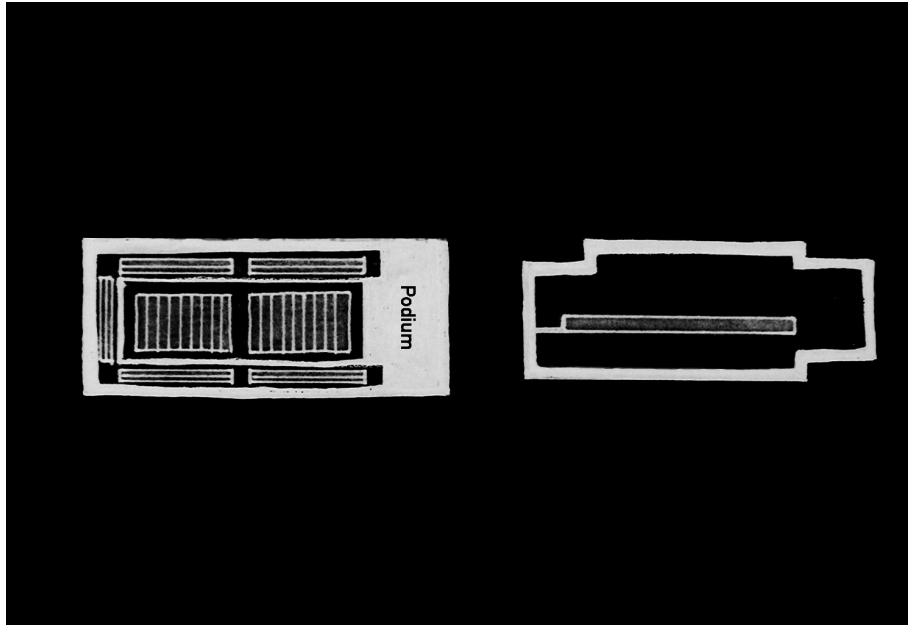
Quader-Saalform (Grundriss, Längsschnitt). Skizzen: Sian Brehler, 2006.
